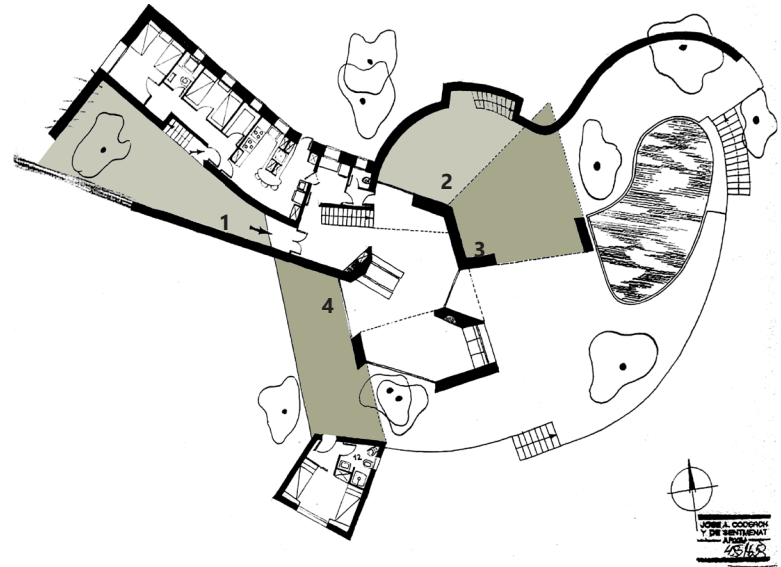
Engawa* Casa Ferrer Vidal, definido a través de planta y sección.
